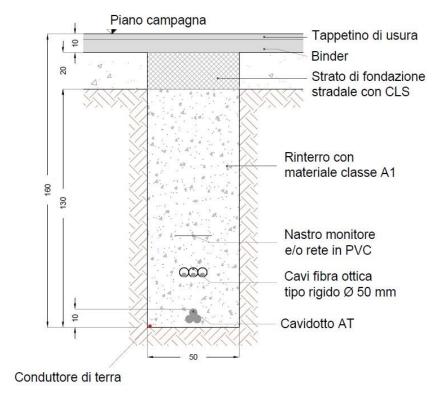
Sezione tipo cavidotto AT una terna su strada asfaltata
